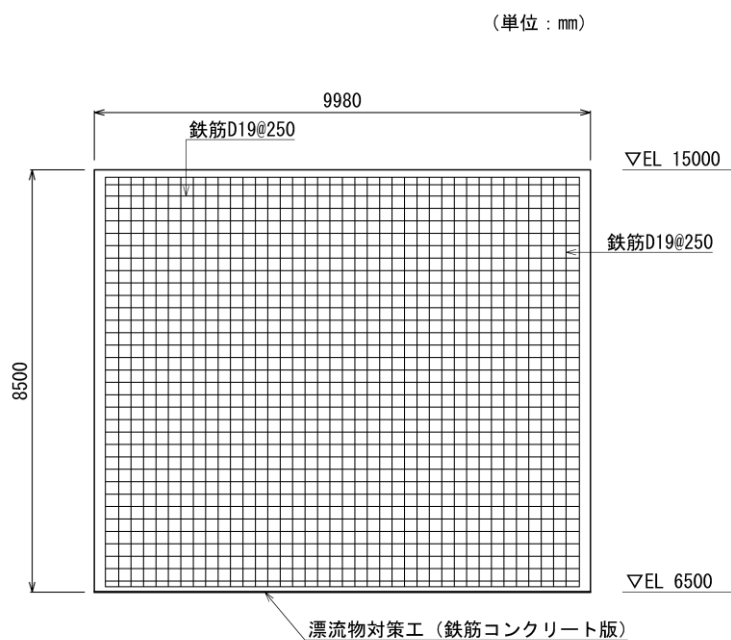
(1) 防波壁 (波返重力擁壁) 重力擁壁における漂流物対策工 (鉄筋コンクリート版) の概略配筋図 (正面図)
